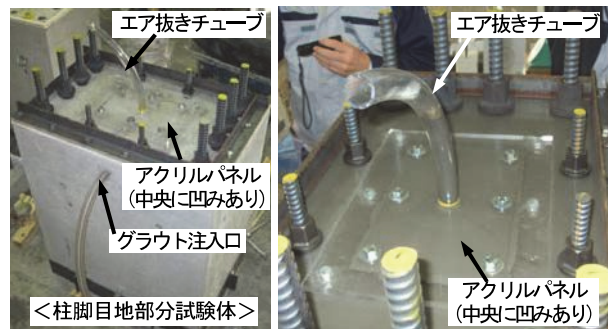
事前実験試験体 写真-5 柱脚目地部分充填状況
